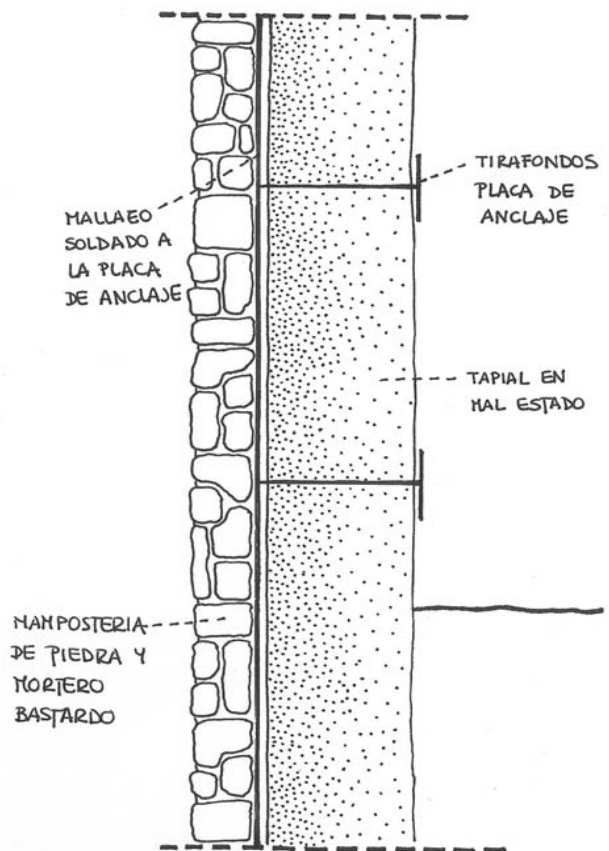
Esquema de intervención con mampostería, elaborado a partir de los detalles consultados en el expediente PI 0926.07.
